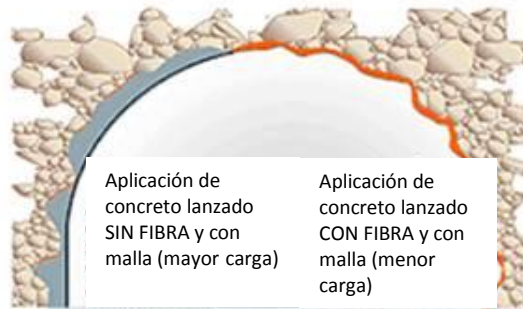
Aplicación de Concreto lanzado con fibras y sin fibras en túneles
